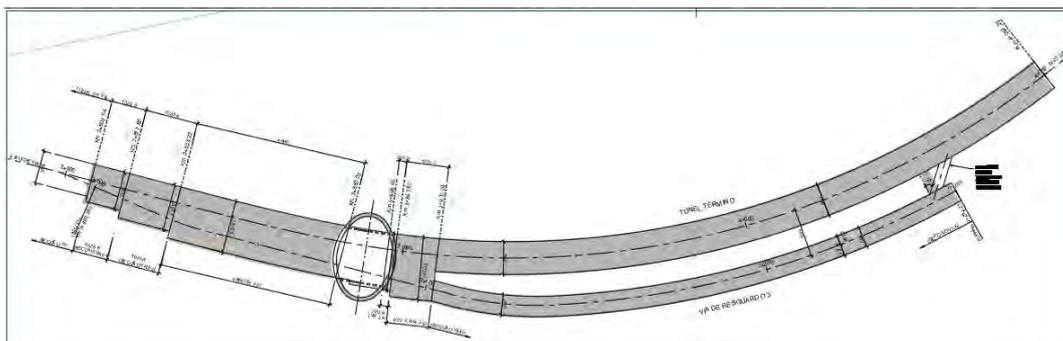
Definição da Via de Resguardo 3. Planta de implantação
